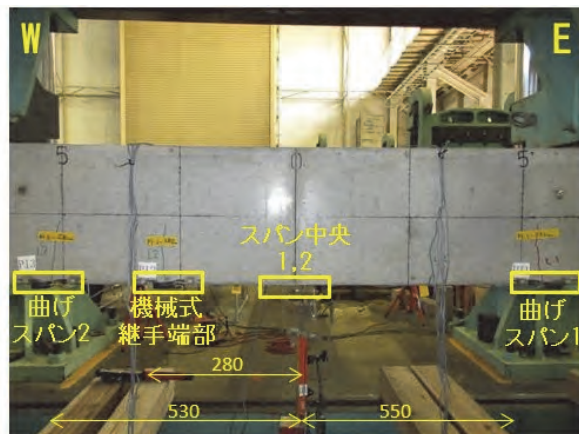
曲げひび割れ幅の測定位置の概要
